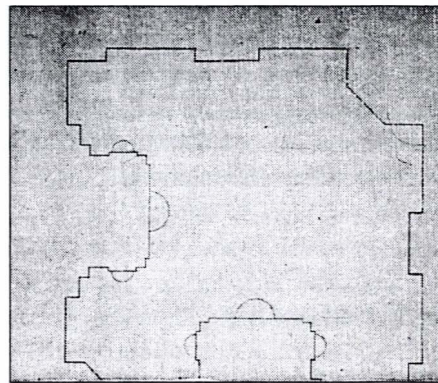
Planta de las columnas de la iglesia de El Escorial
